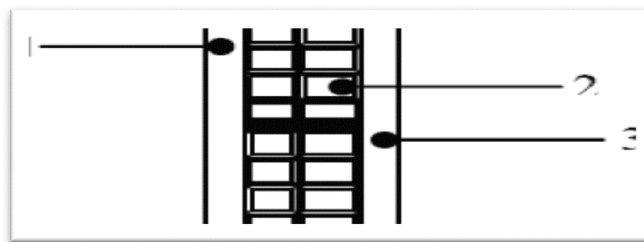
b) : Coupe verticale d'un mur intérieur
